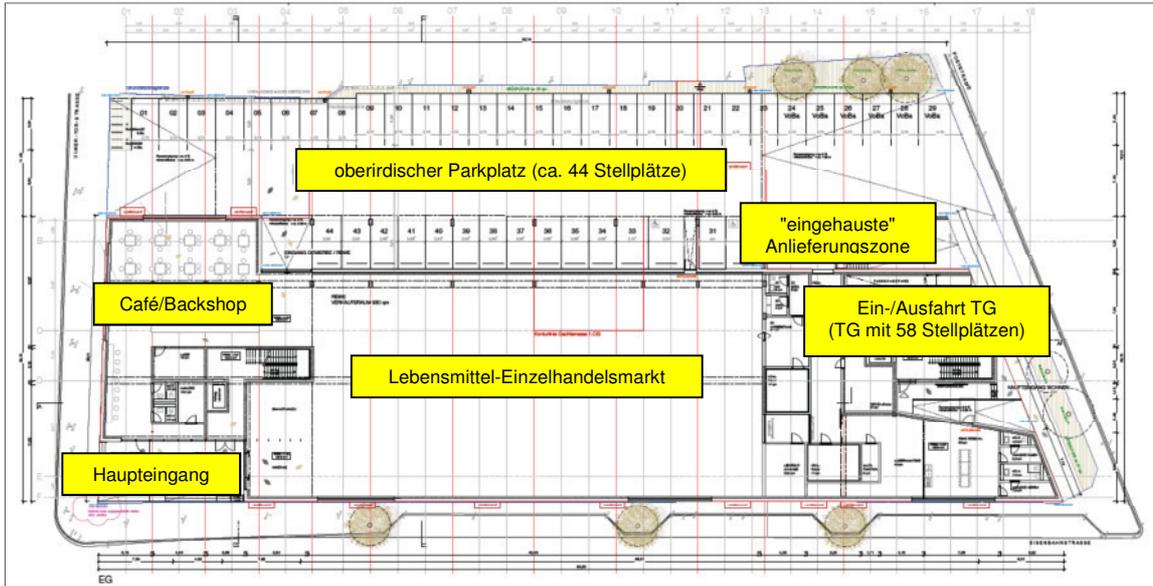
Ausschnitt geplanter Grundriss Erdgeschoss (EG) des Bauvorhabens mit Darstellung der vorgesehenen Gewerbeeinheiten, oberirdischen Pkw-Parkplätze sowie Ein-/Ausfahrt Tiefgarage gemäß [c]
